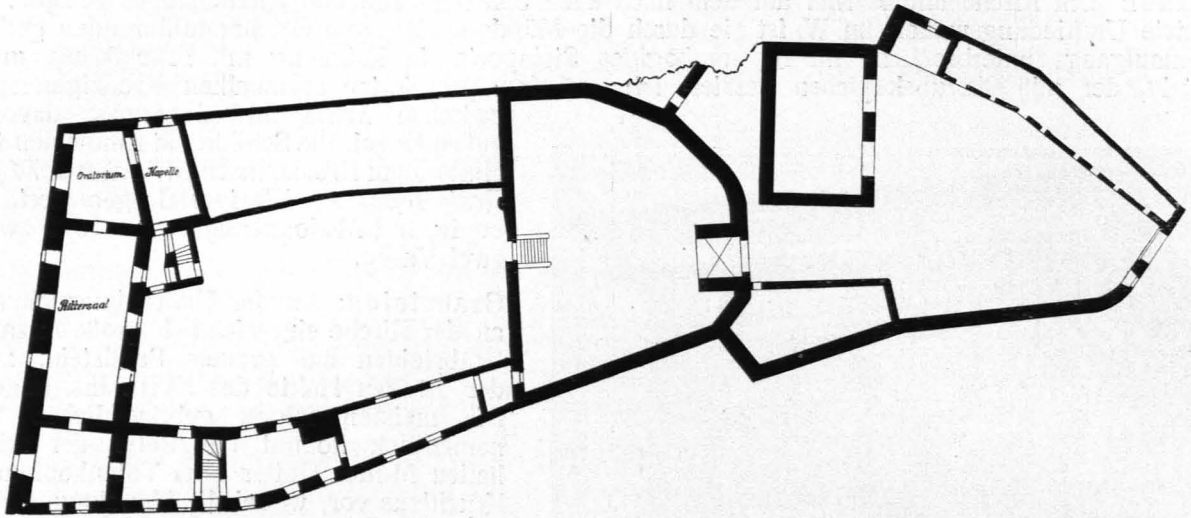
Burgschleinitz, Schloß, Grundriß 1 : 600 (S. 7)
